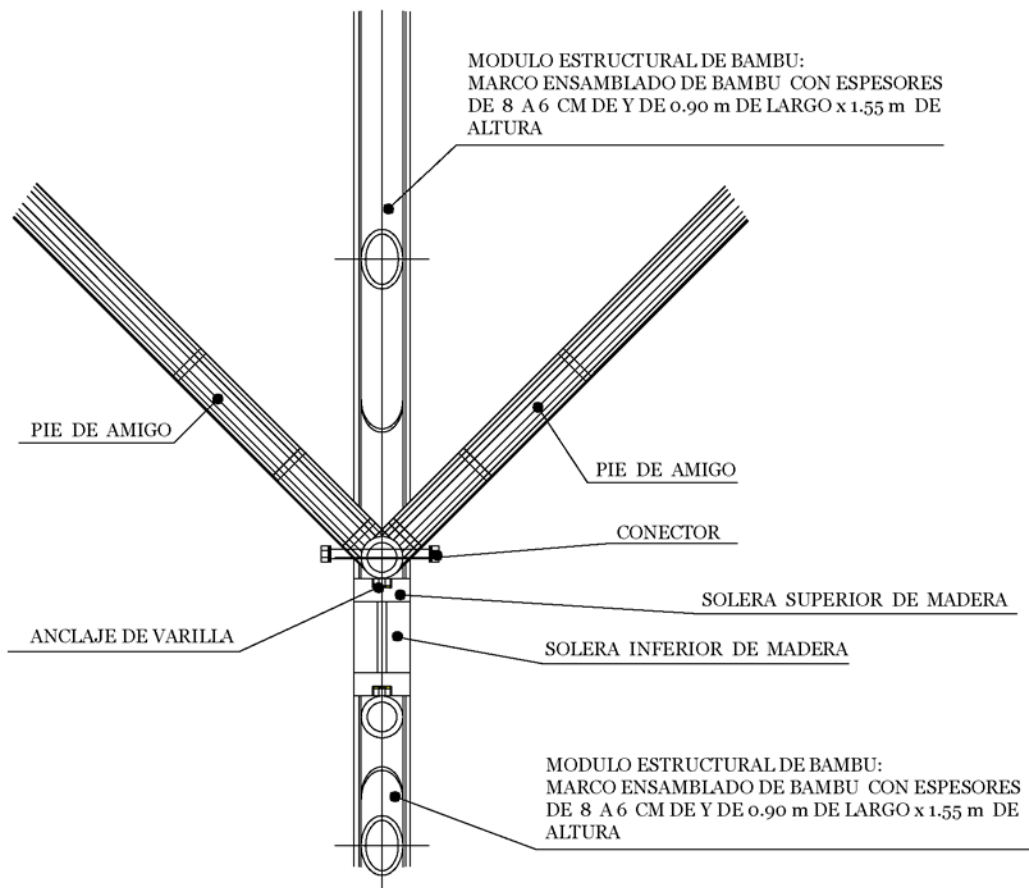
Detalles Constructivos-Estructura M.
